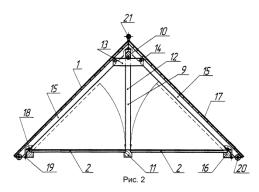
Двускатная крыша с откидным и панелями потолка: 1 - крыша; 2 - панель потолка; 9 - ферма; 10 - коньковый брус; 11 - лежень; 13 – ригель; 14 - шарнир; 15 - стропило; 16 - мауэрлат; 17 - кровельное покрытие; 19 - полушарнир; 20 - технологическое колесо; 21 - рым-болт.
